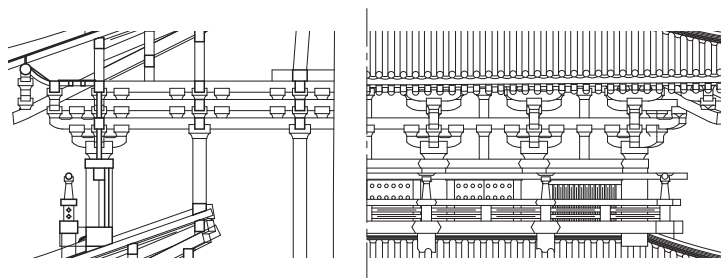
天平塔 二重部分立面図 1 : 200
